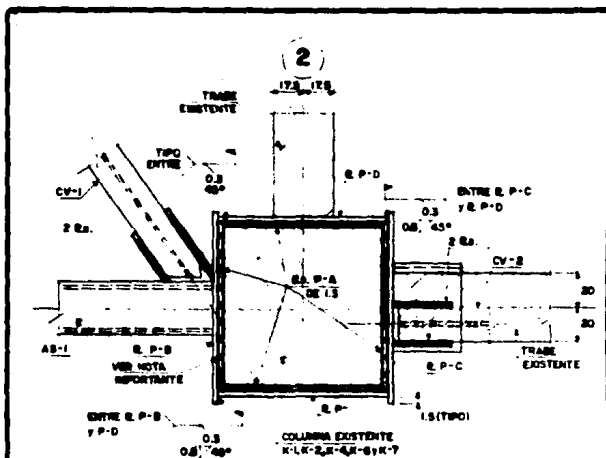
DETALLE DE UNIÓN ENTRE COLUMNA DE CONCRETO Y CONTRAVIENTOS METÁLICOS (PLANTA)
